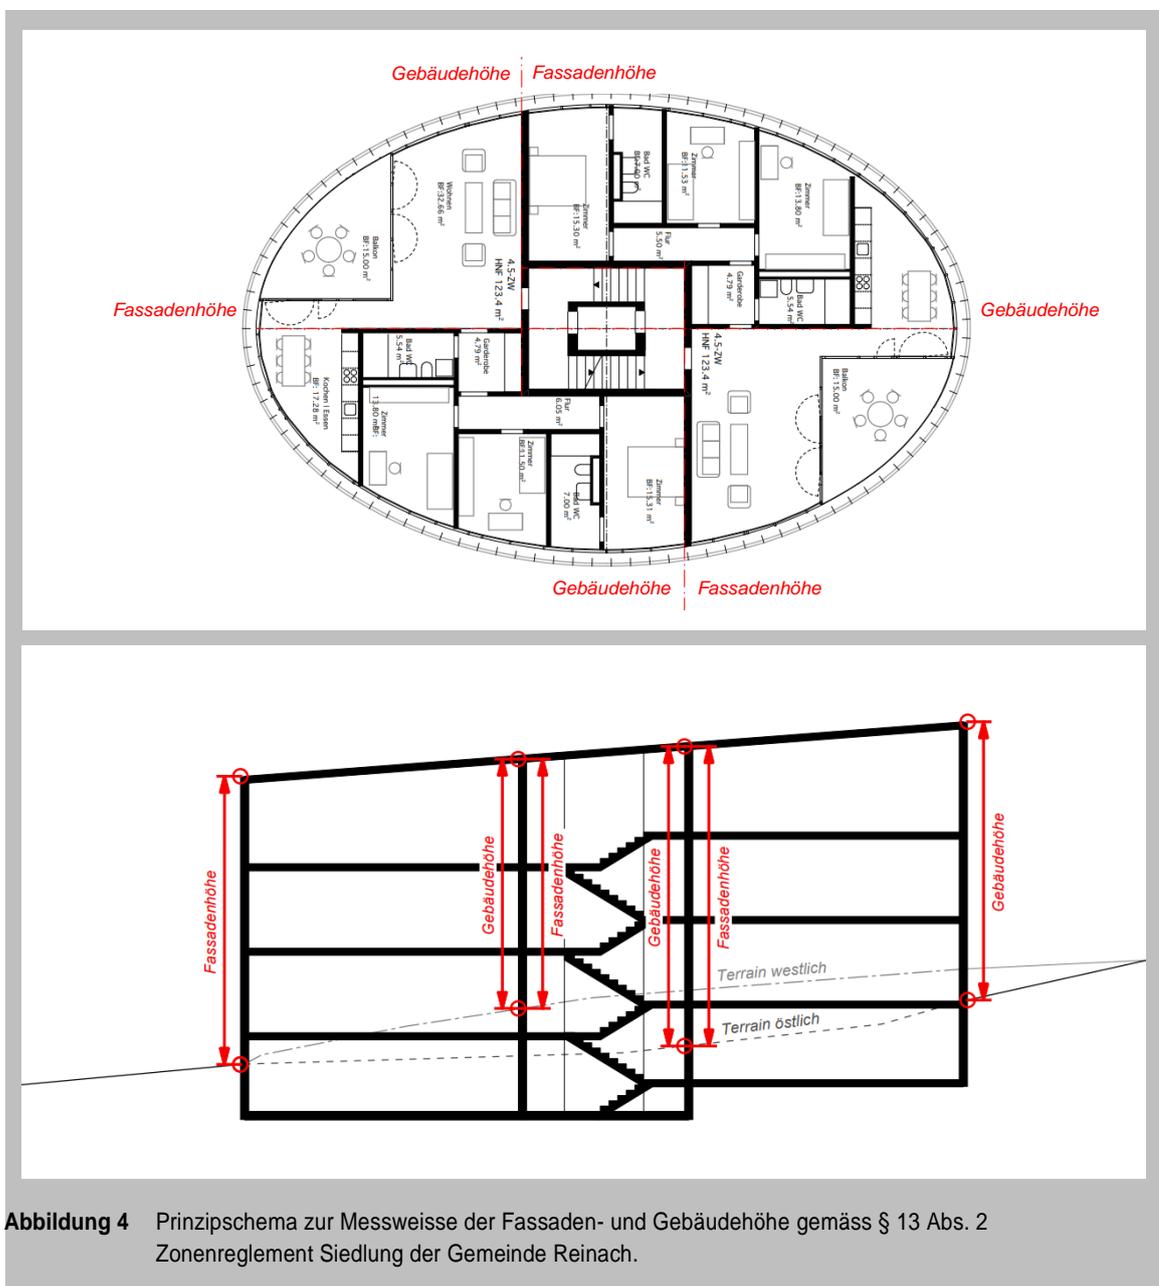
Prinzipschema zur Messweise der Fassaden- und Gebäudehöhe gemäss § 13 Abs. 2 Zonenreglement Siedlung der Gemeinde Reinach.
